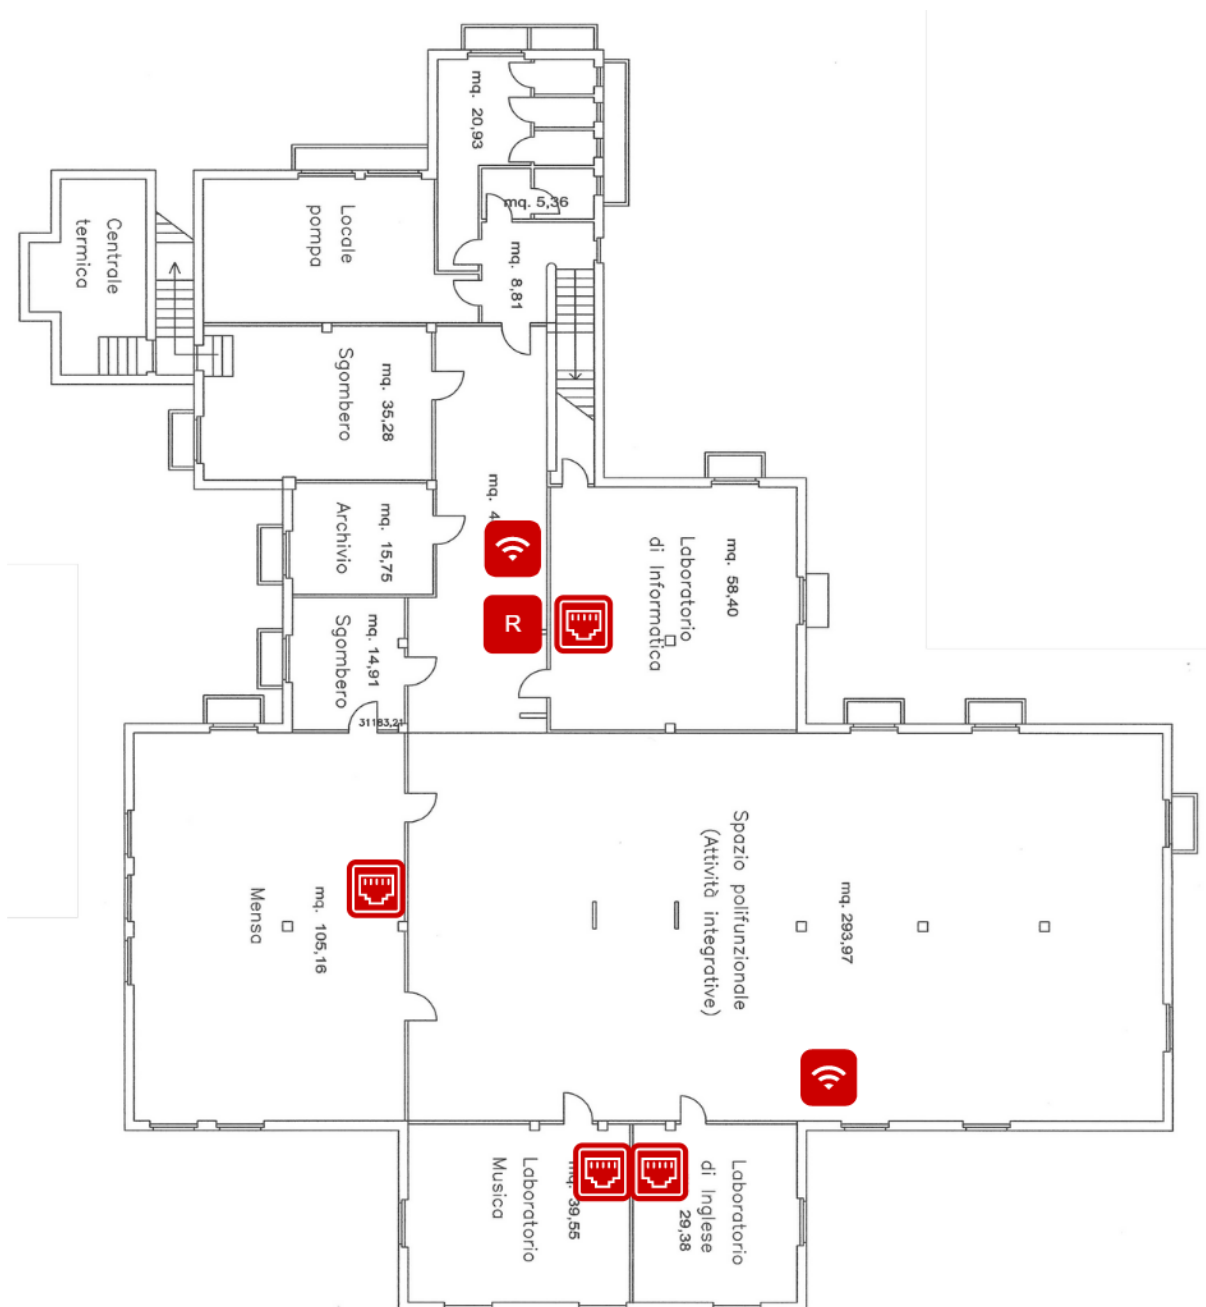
Planimetria Scuola Primaria di Somaino - Piano seminterrato
